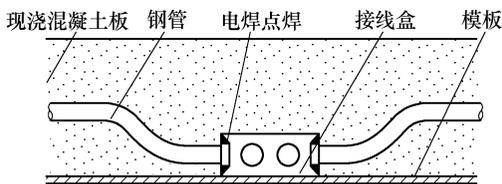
现浇柱钢筋混凝土楼板上灯盒预埋示意图
